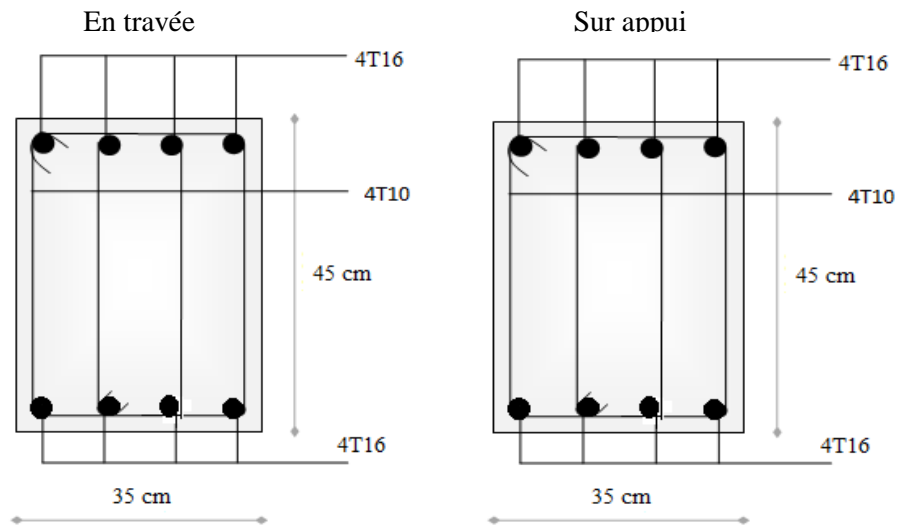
Ferrailage des poutres porteuses sous-sol
